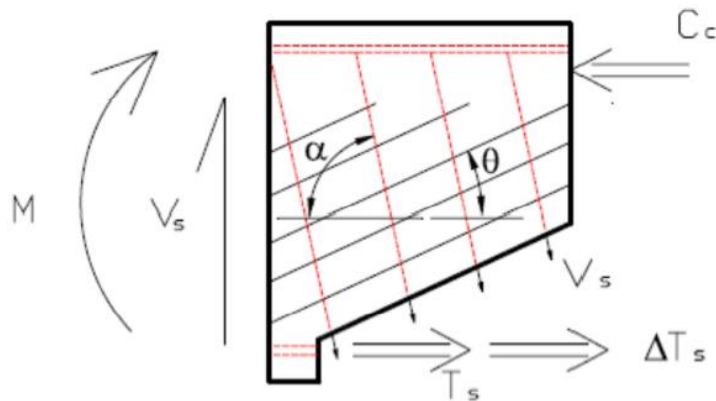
Mecanismo de las armaduras transversales para resistir cortante.
